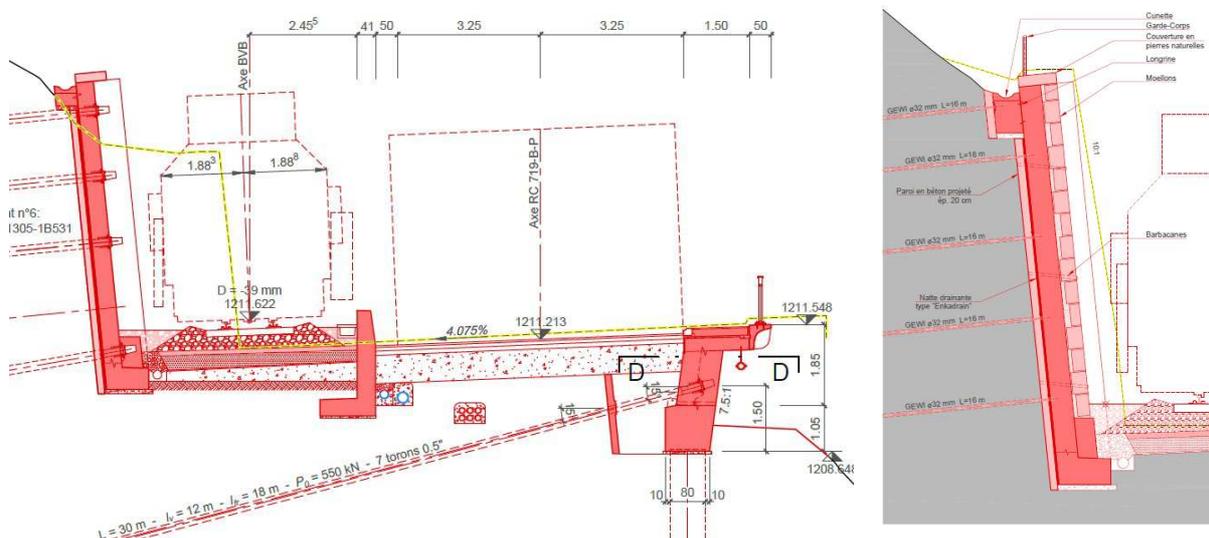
Coupes types du mur de soutènement à contreforts (à gauche) et du parement du mur (à droite)
